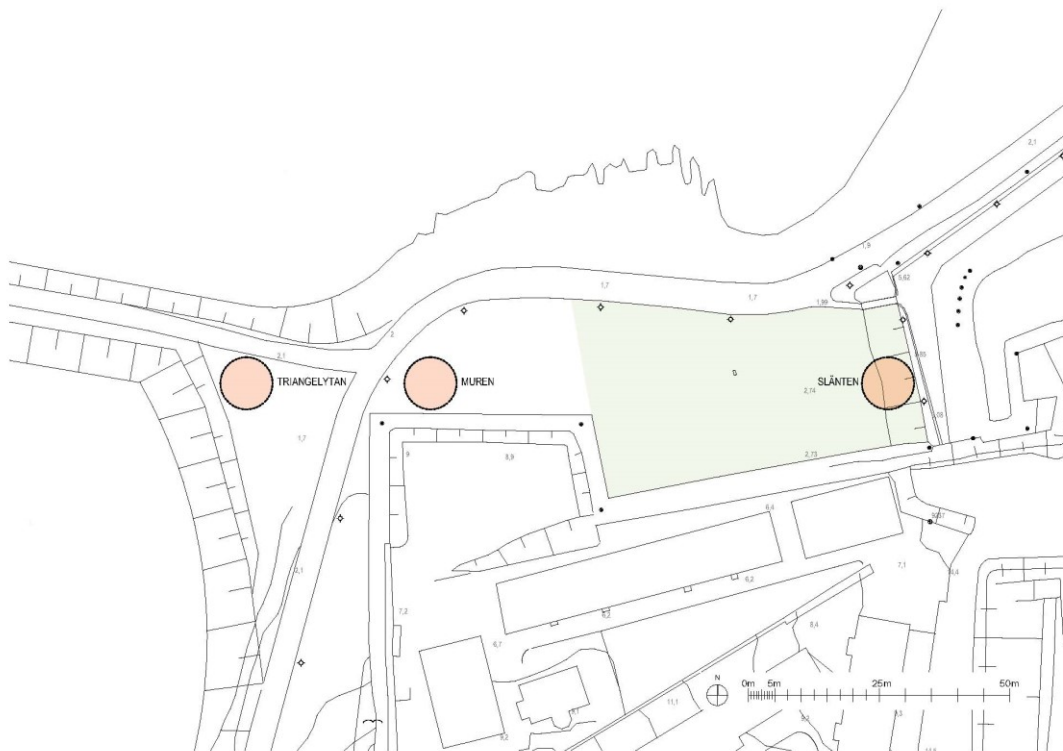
Situationsplan med placering av de tre förslagen, Slänten, Muren och Triangelytan.
